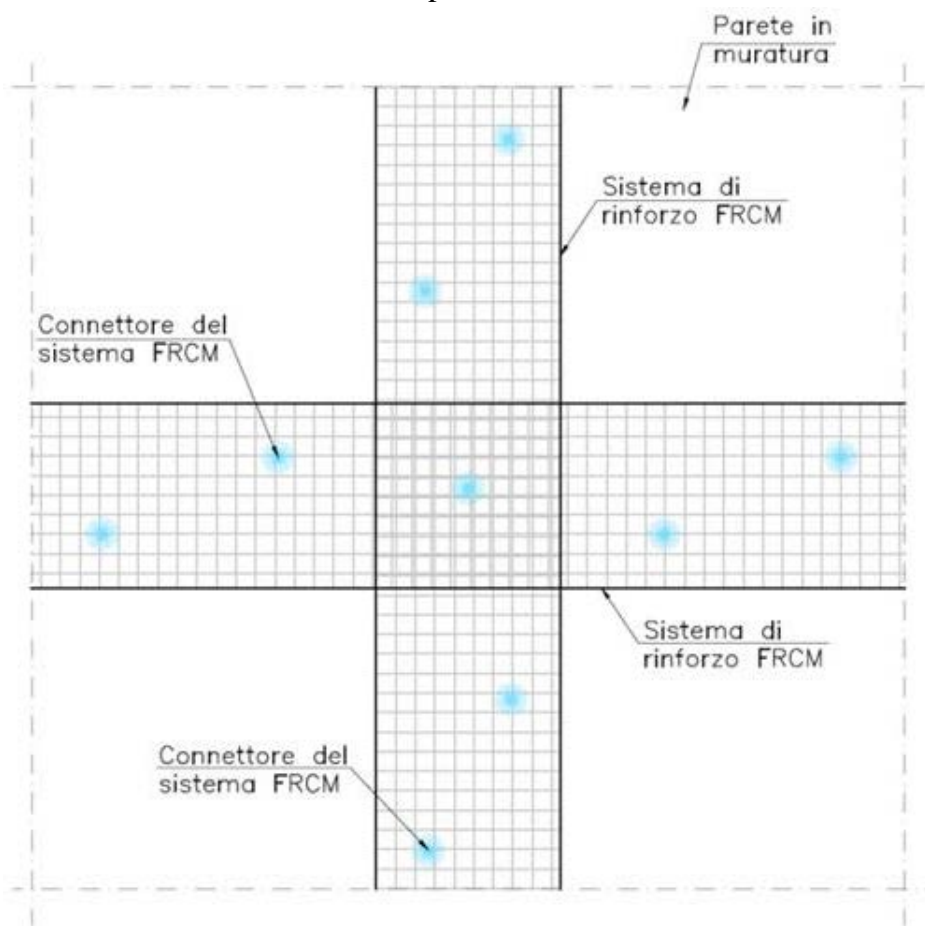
disposizione dei connettori nelle fasce di rinforzo nel caso di cordolature di piano (prospetto)
